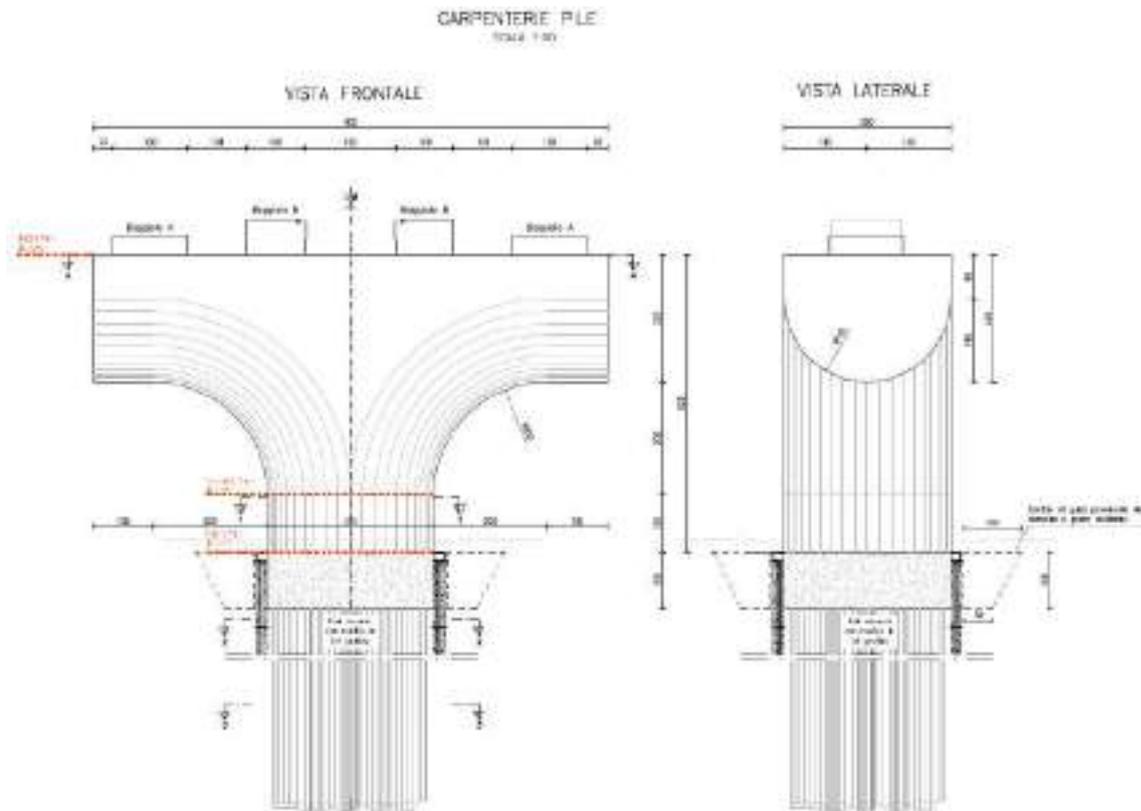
Carpenterie delle pile: elevazioni in vista frontale e laterale.
